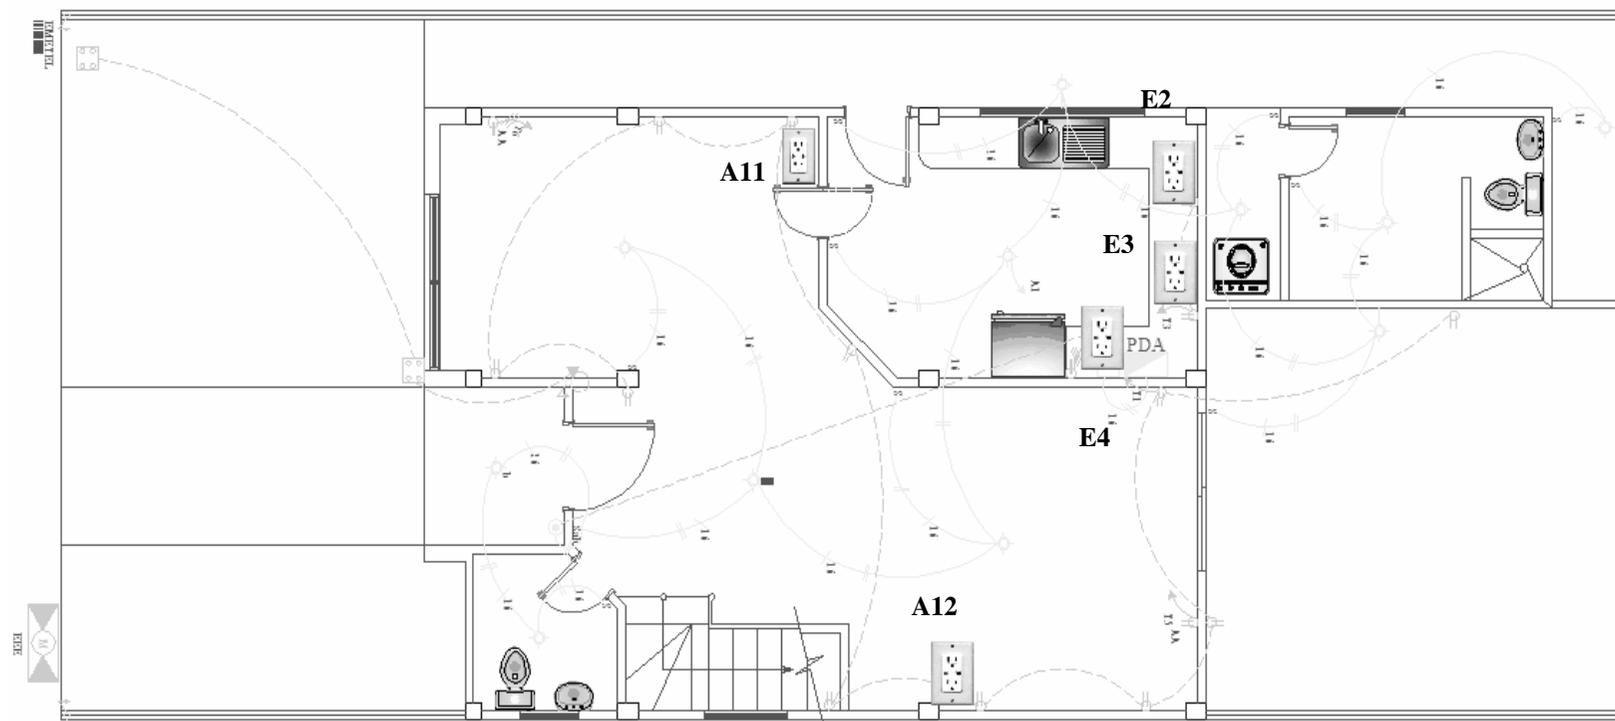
Sistema de Control, Planta Baja, Plano Eléctrico.
